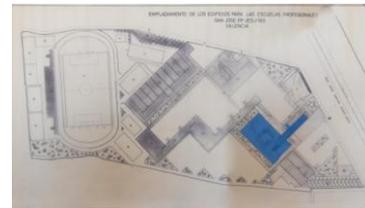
Planta salón de actos. Archivo Escuelas San José.
